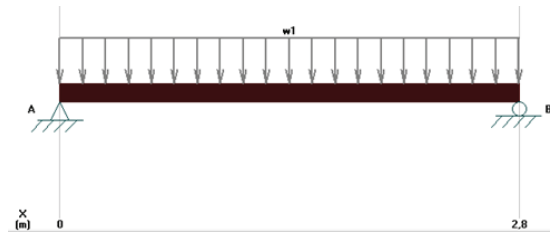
Viga simplemente apoyada (Fuente propia)
